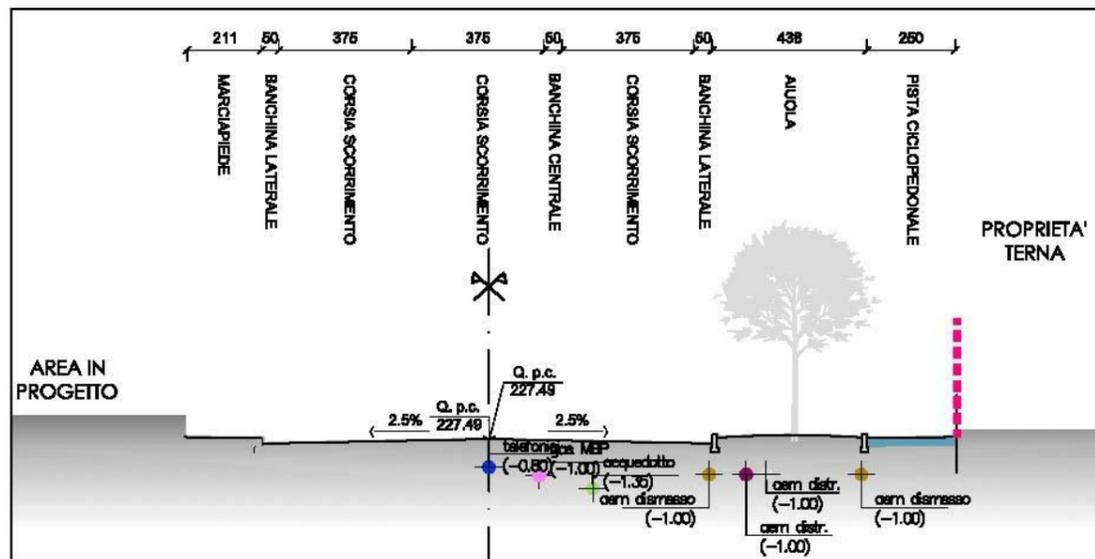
Strada Basse di Stura sez.4 – PROGETTO
